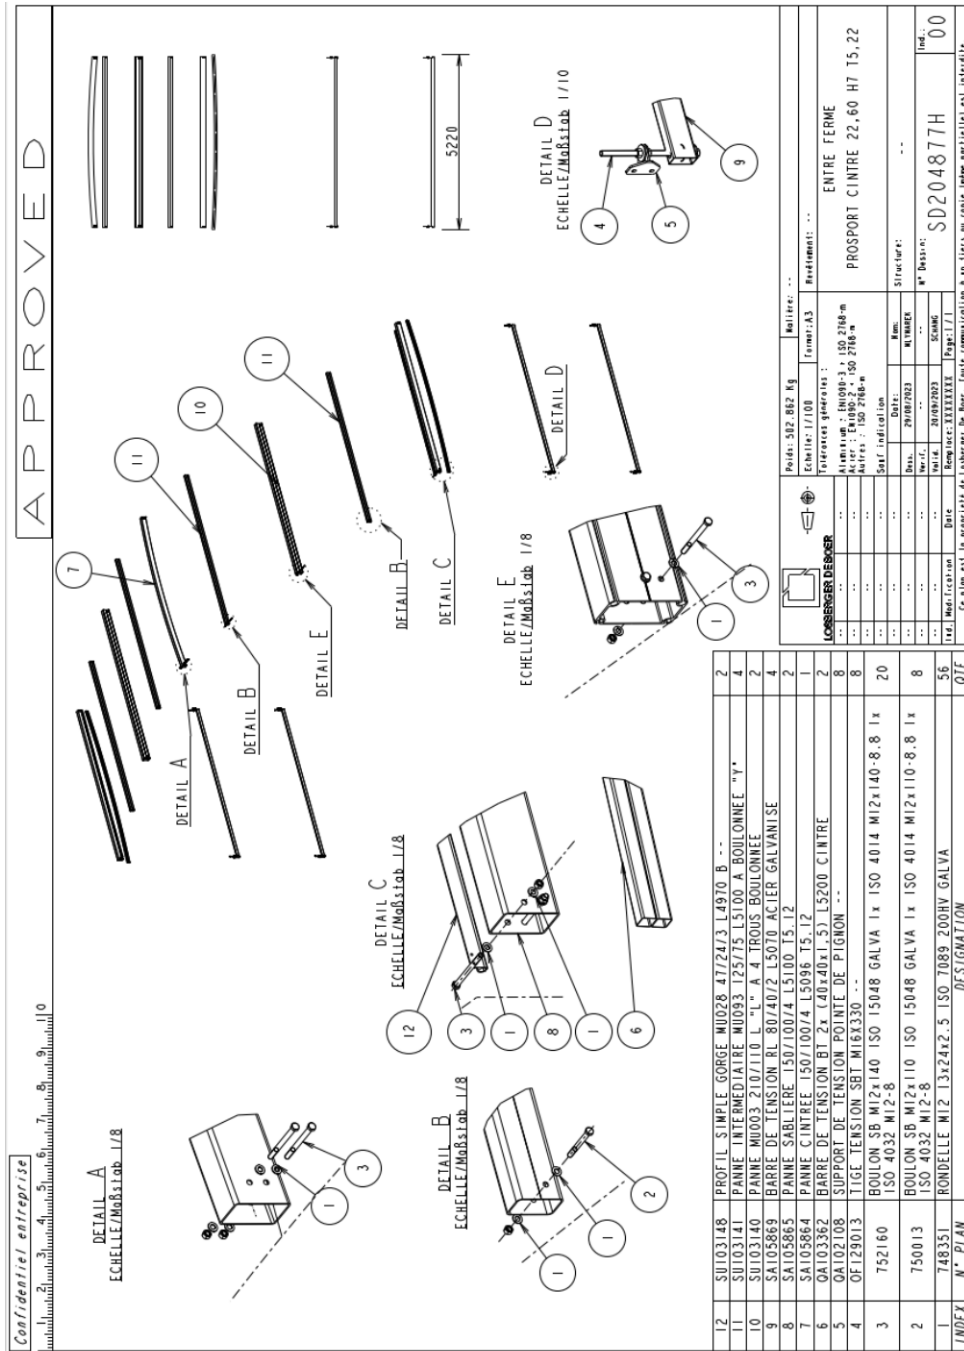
Système de façade par éléments de travée – toiture cintrée
